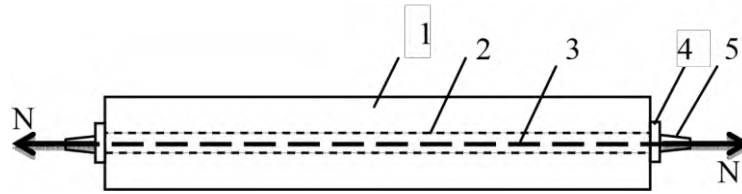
Схема натягу залізобетонного елемента на бетон: 1 - готовий бетонний виріб, 2 - швелер, 3 - попередньо напружена арматура, 4 - анкерний пристрій, 5 - натяжний пристрій (домкрат).
